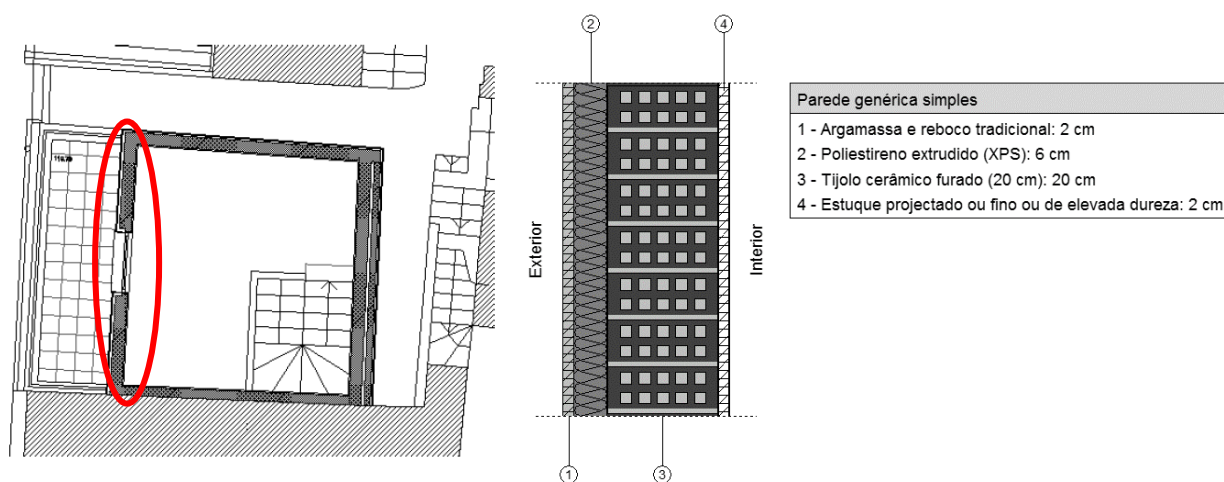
Identificação e pormenor construtivo da parede Pe1.
